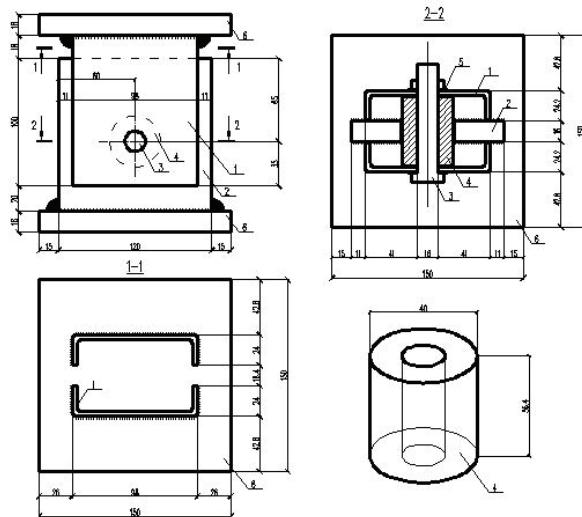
Опытный образец: 1 – холодногнутый профиль с трапециевидной стенкой; 2 – листовая фасонка; 3 – болт; 4 – сквозная втулка; 5 – шайба; 6 – объединяющая пластина
